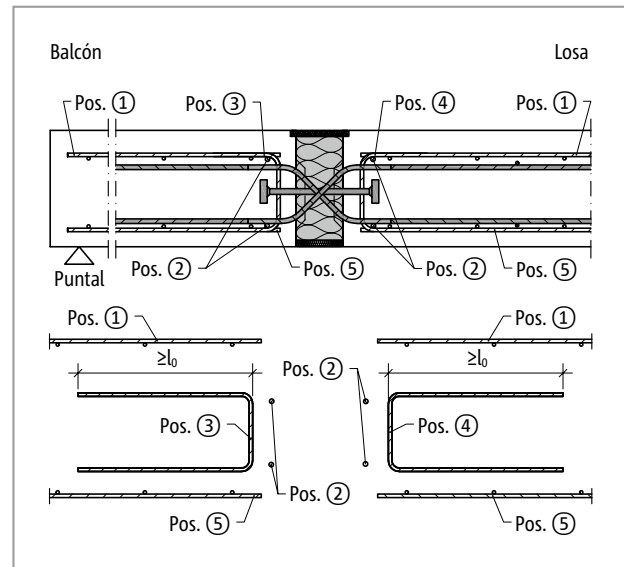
Schöck Isokorb® T tipo Q-P-VV: Armadura in situ
